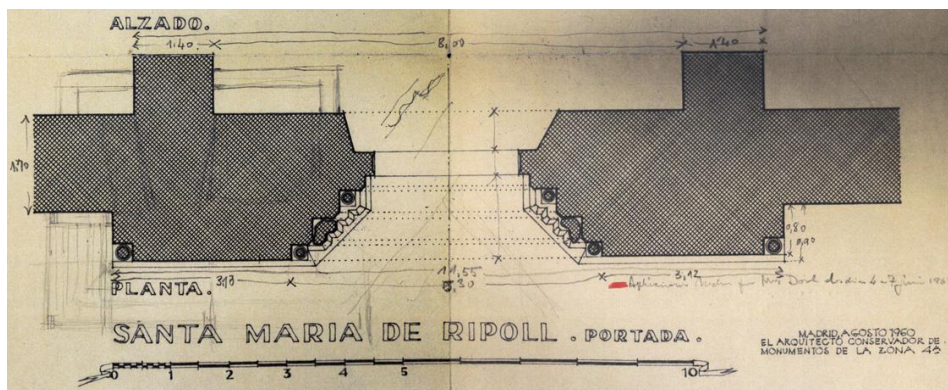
Ripoll Monasterio de Santa María AAFV. Plano de sección de la portada con cotas
